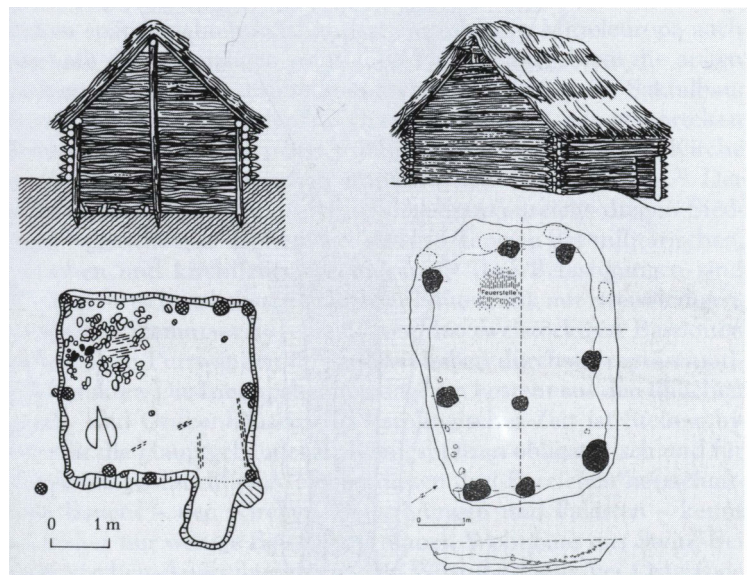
Grundriss und Rekonstruktion eines Grubenhauses
